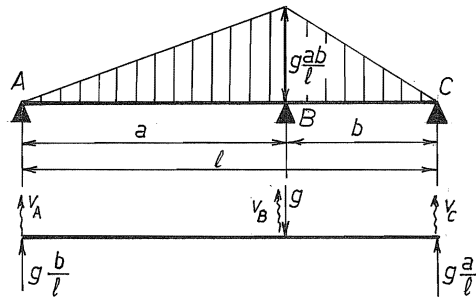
État d'autocontrainte de la poutre sur trois appuis.
